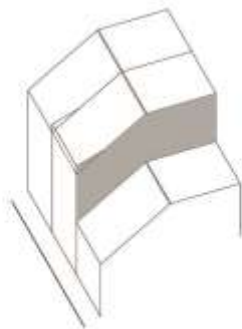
| Empena lateral com recorte comum e coroamento misto de duas águas e platibanda ou murete. Pode ocorrer quer na fachada principal, quer na posterior. (desenho do autor)
